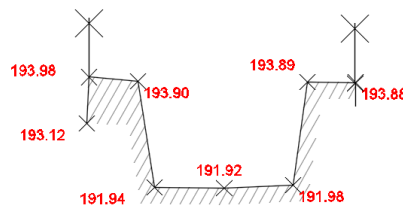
Section du canal au niveau de l'ouvrage de délestage du Tarze
